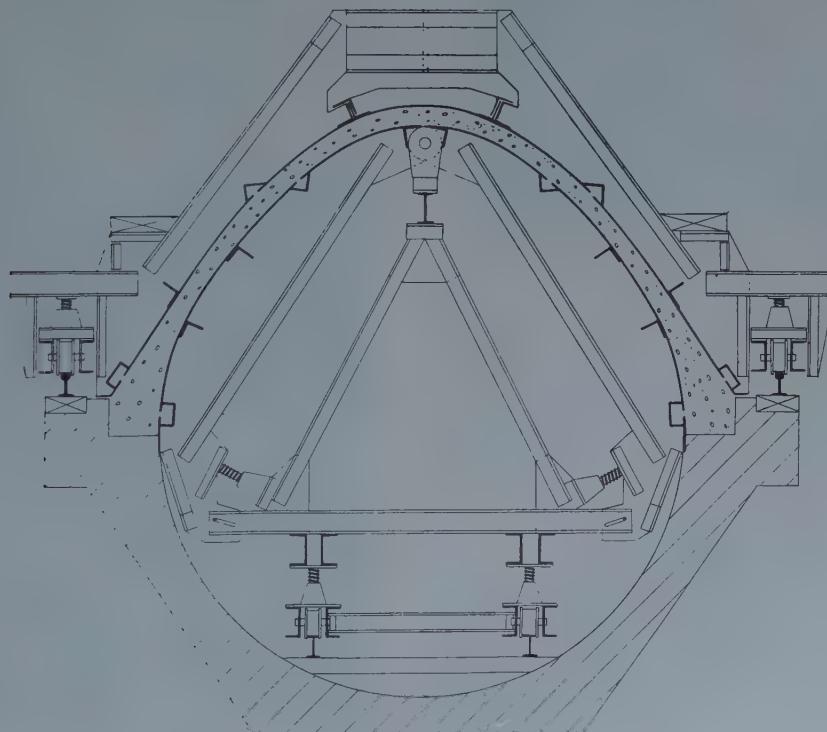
Ensemble du coffrage Vacuum pour la voûte parabolique de couverture de la zone 5-6.
